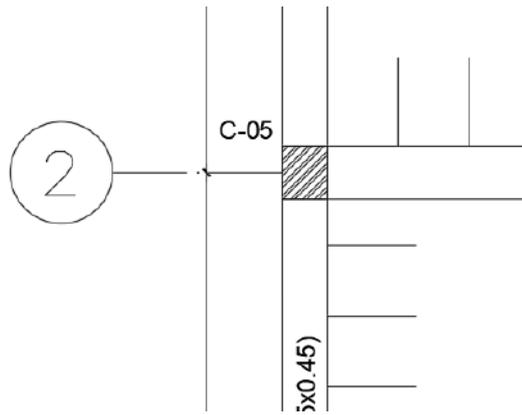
Columna entre los ejes 2-A. Fuente: Propia.
